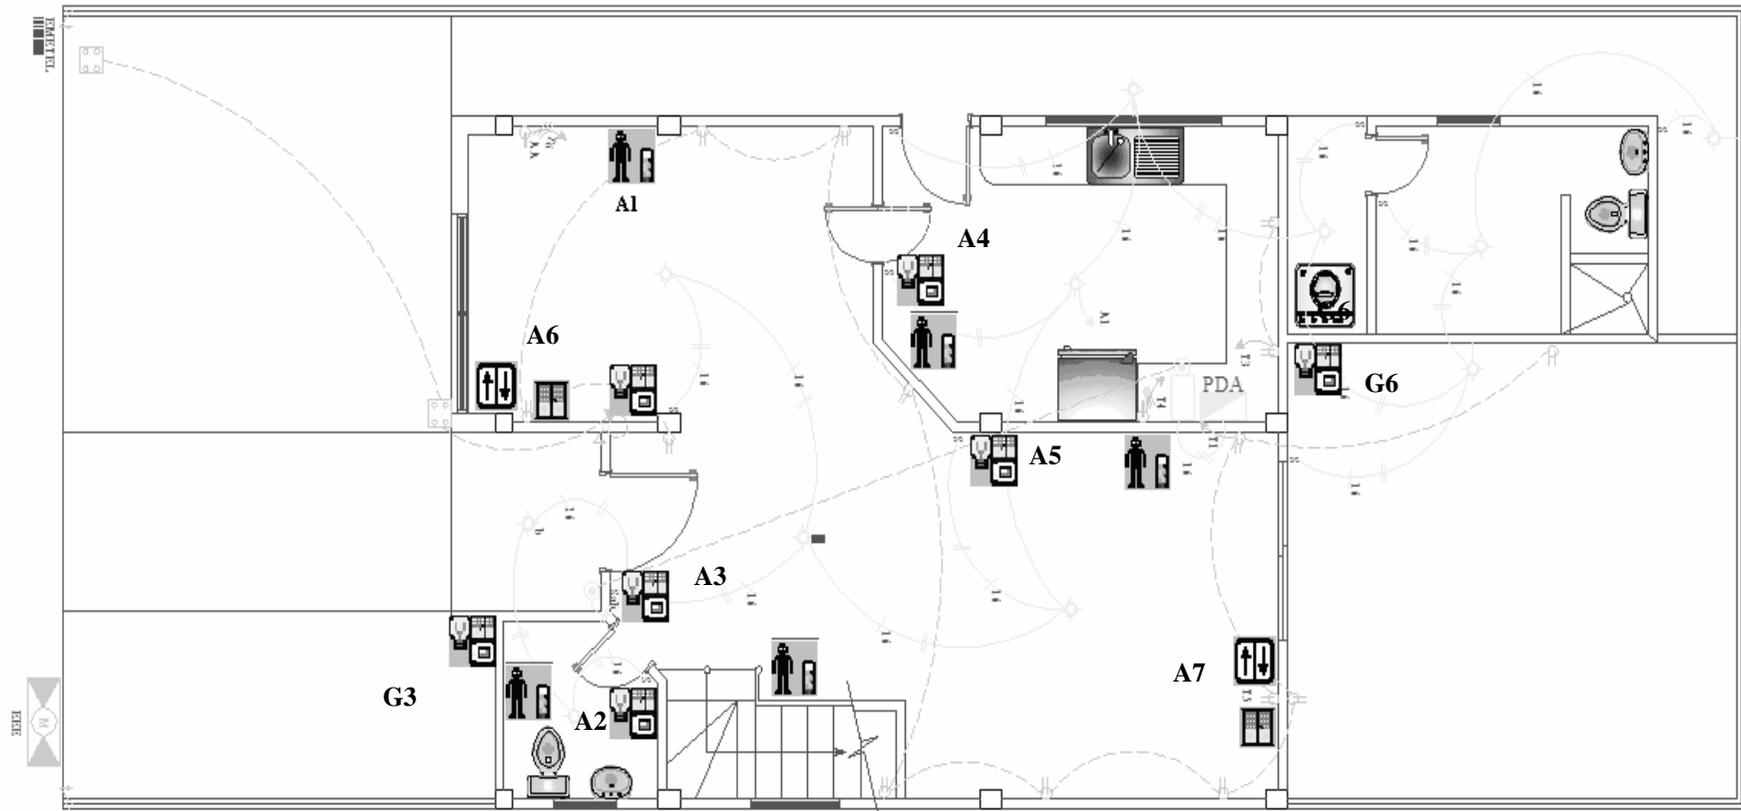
Sistema de Iluminación, Planta Baja, Plano Eléctrico.
